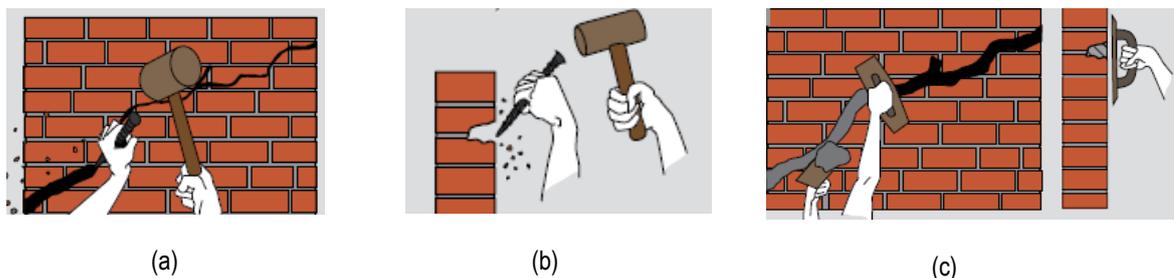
Procedimiento de reparación de grietas en muros de mampostería (UC,2010).
